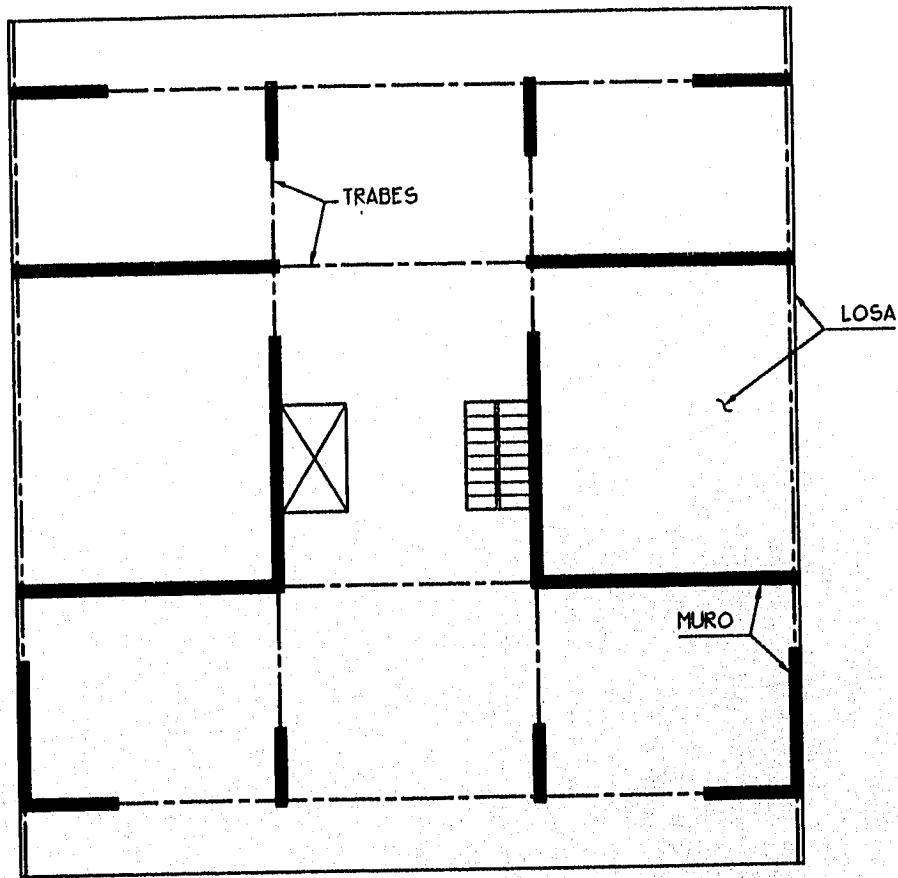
SISTEMA A BASE DE MUROS Y LOSA
